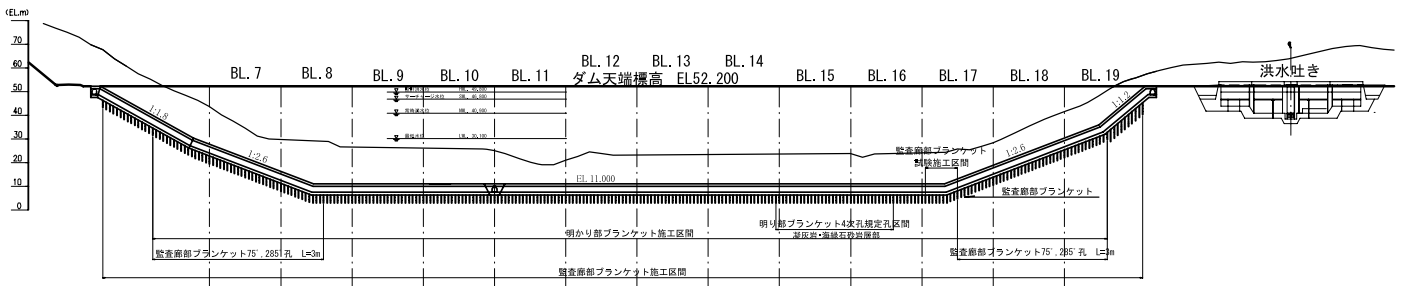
ダム縦断面図(監査廊部ブランケットグラウチング縦断面図)
